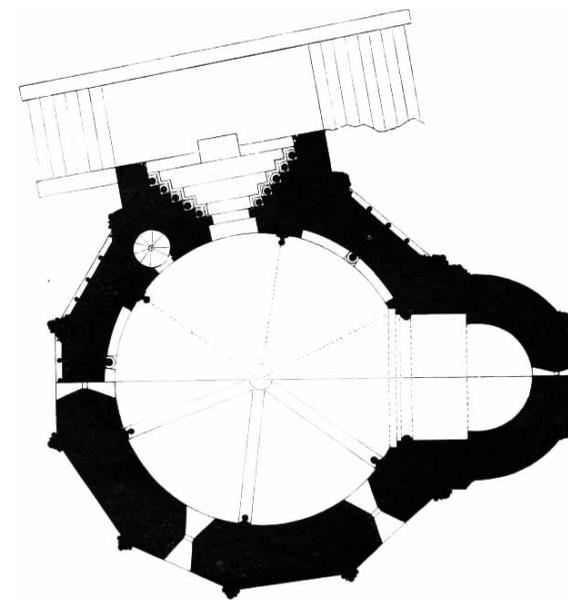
Grundriss Tulln (DM 10,60 m), M 1:200. MdkkCC 18876, 161.
